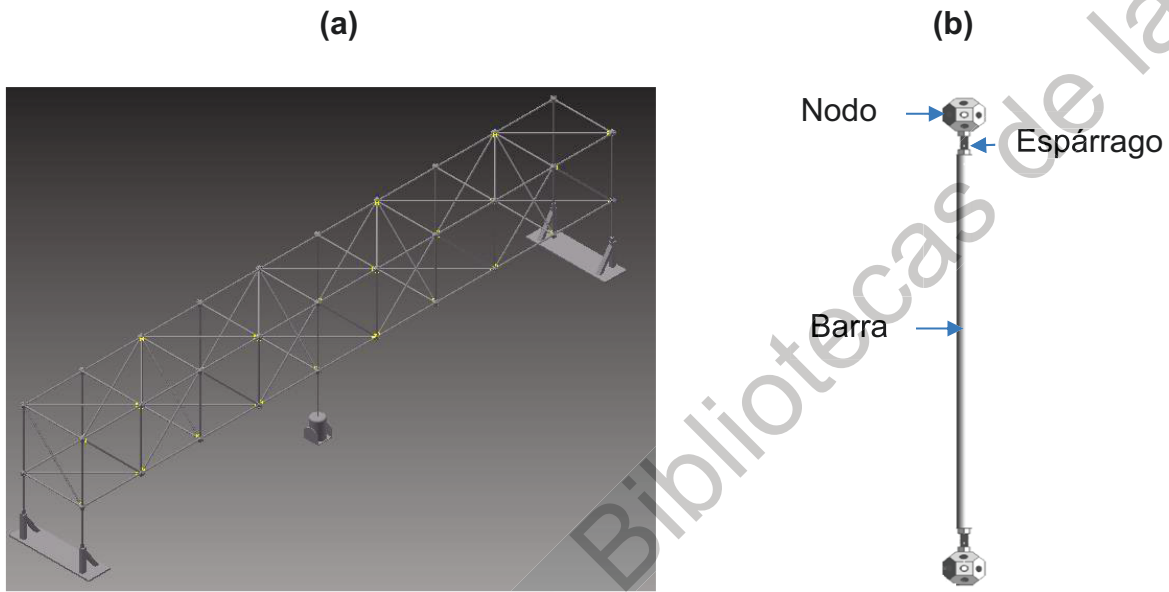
2 Armadura (a) Modelo de la armadura bajo prueba y (b) elemento ensamblado.
